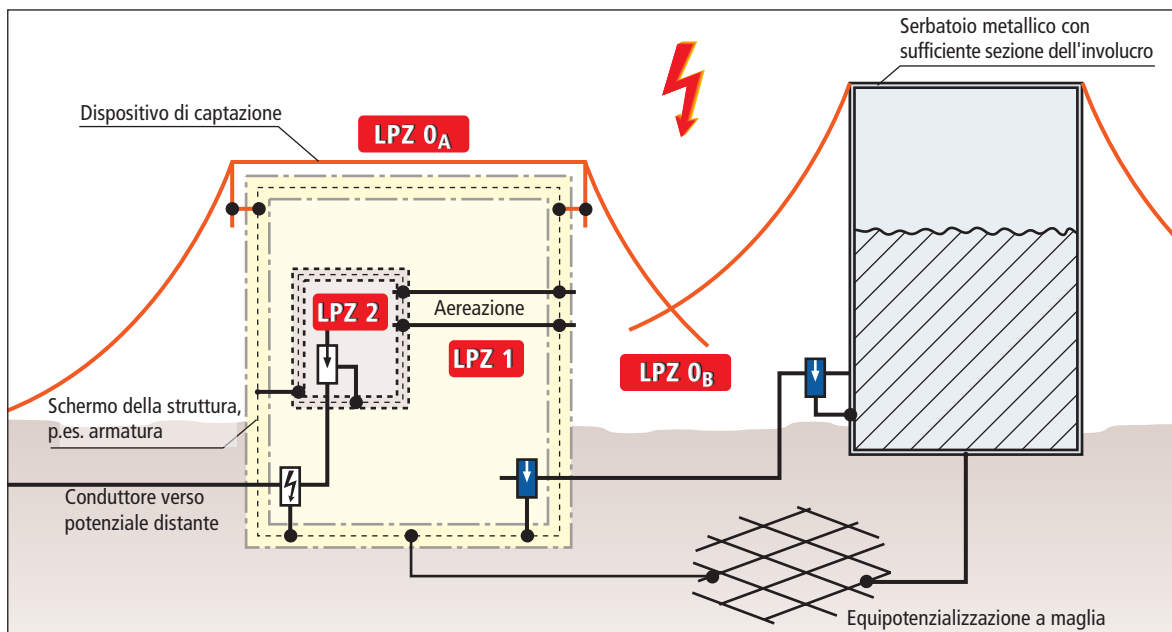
Suddivisione di un impianto EX in zone di protezione da fulminazione (LPZ)
